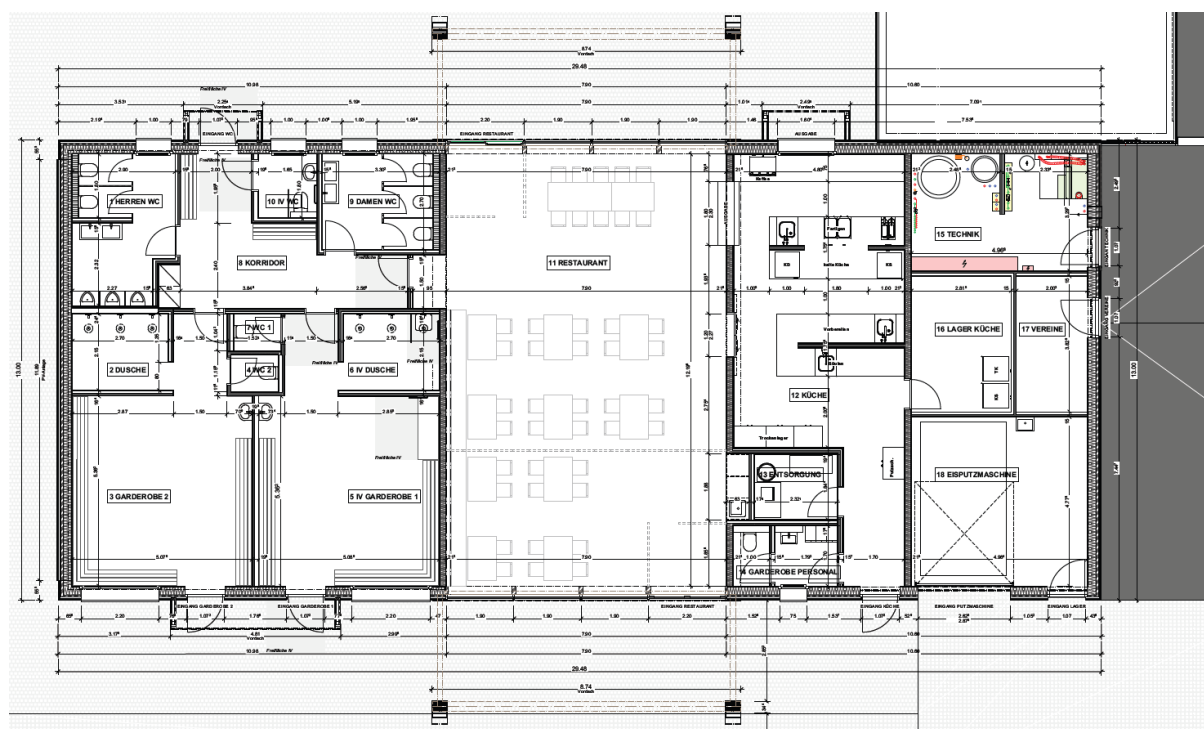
Grundriss Restaurant- und Betriebsgebäude
